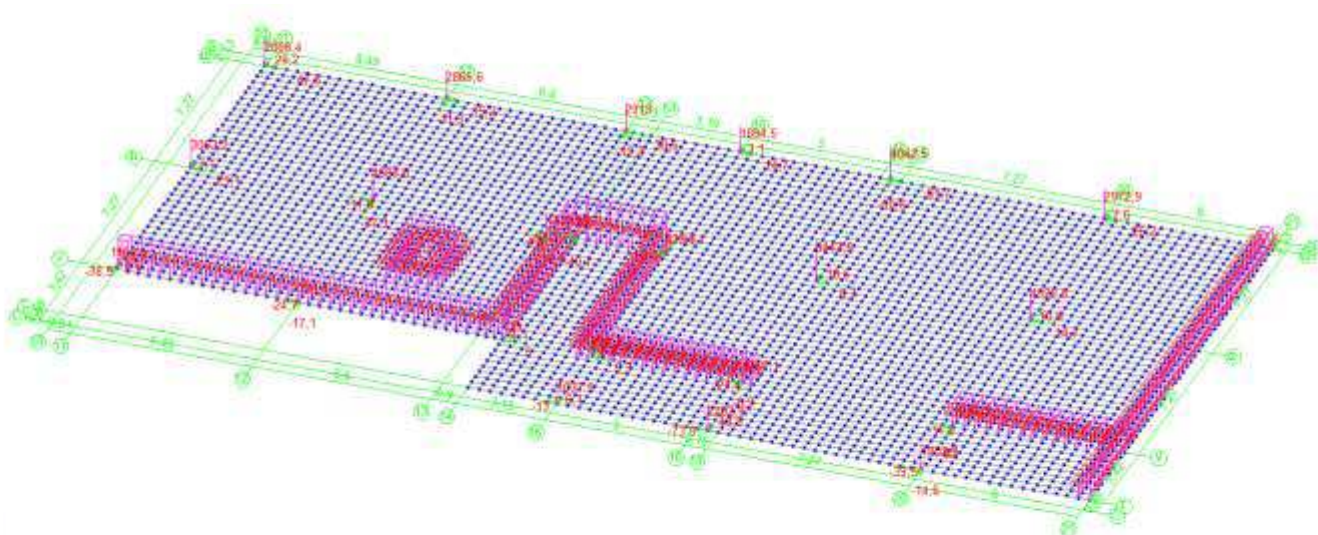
Схема действия нагрузок на фундаментную плиту
